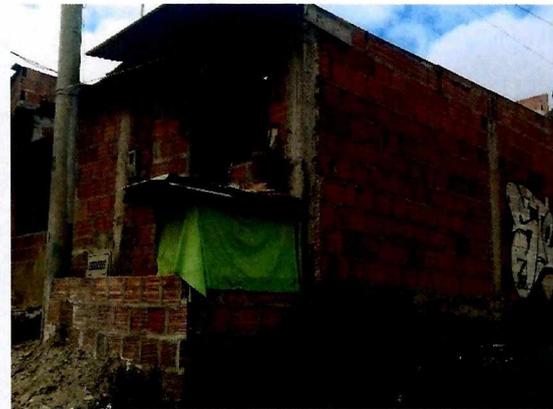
Vista Lateral de Predio 4 de la Manzana 2
